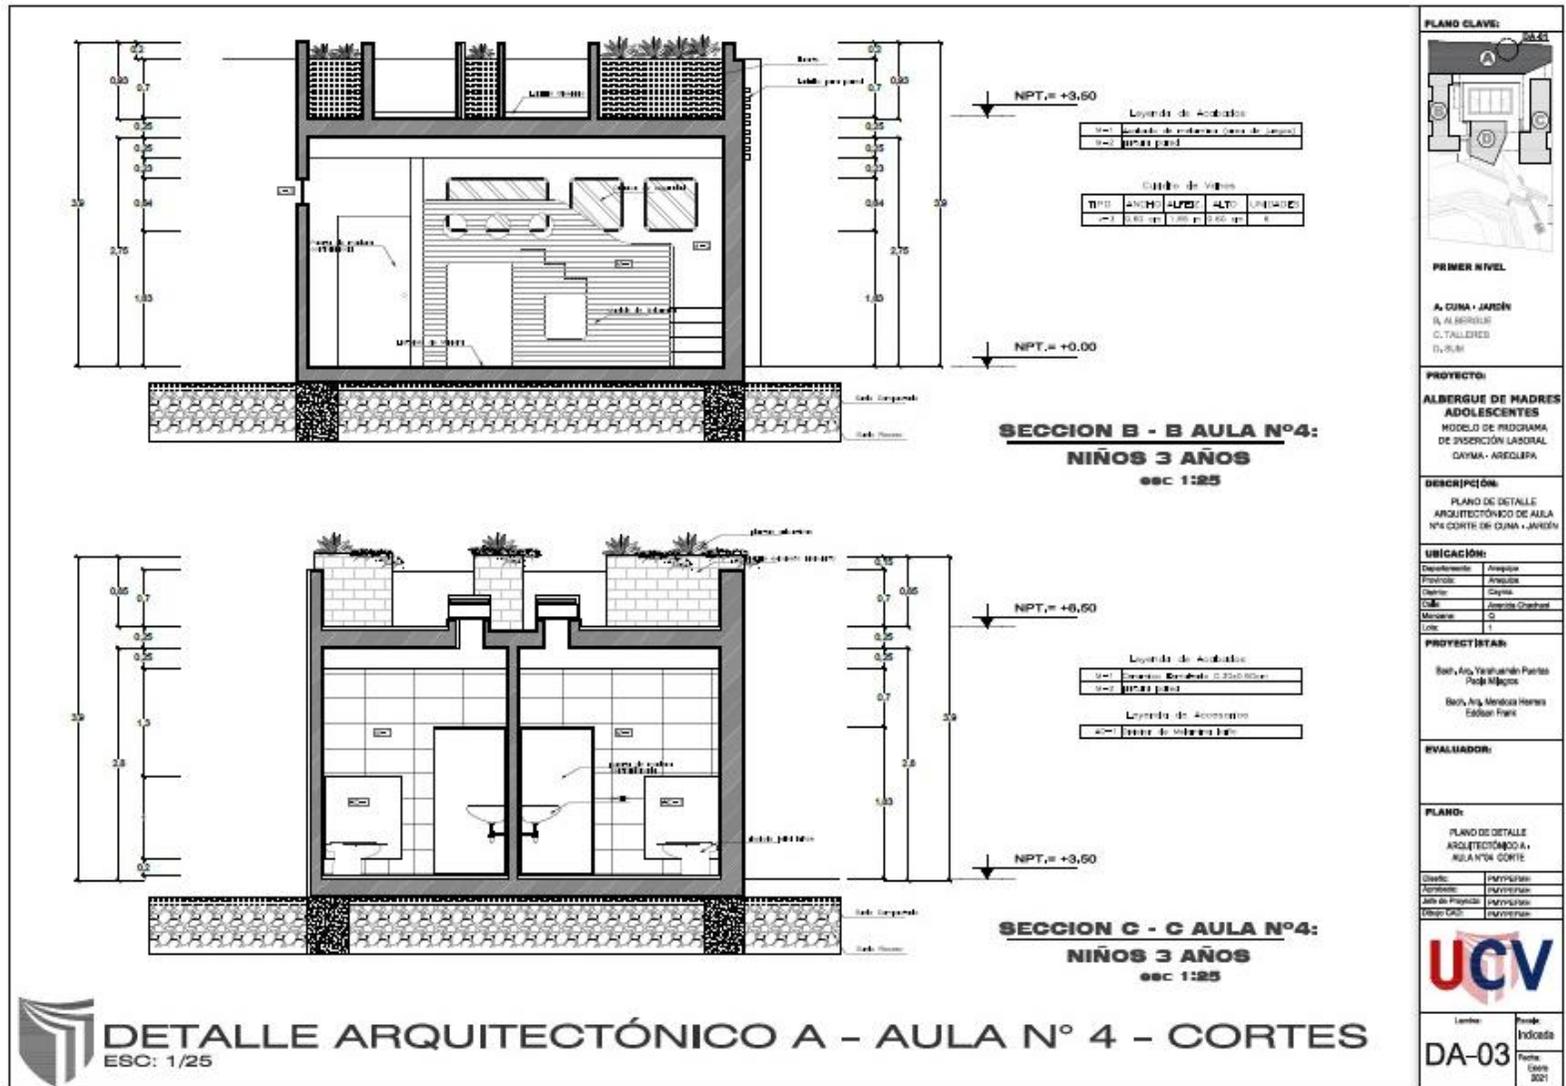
Plano de Detalle Arquitectónico A – Aula N°04 de Cuna Jardín en Corte Transversal DA-03.
